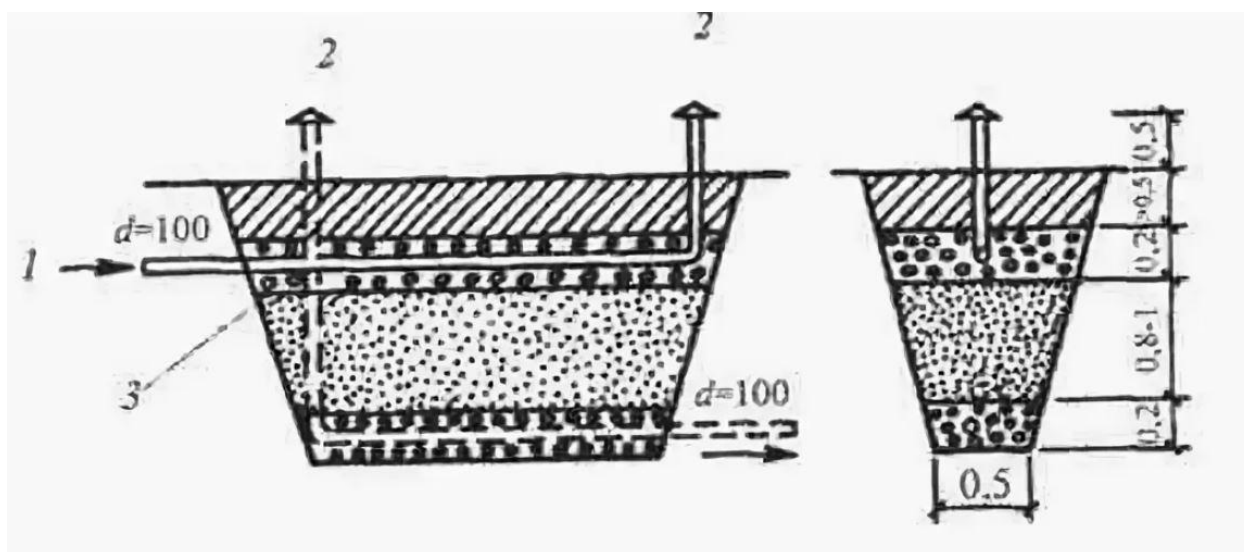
Фильтрующая траншея: 1 – подача осветленной сточной жидкости; 2 – вентиляционная труба; 3 – оросительная сеть; 4 - дренажная сеть
